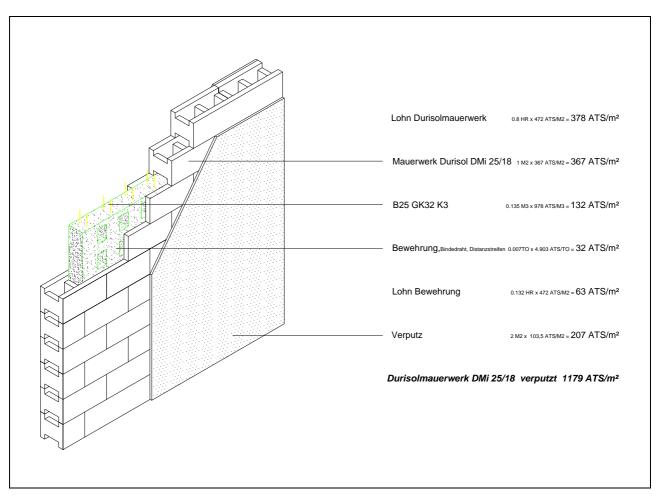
Mantelbetonmauerwerk (BW2)
